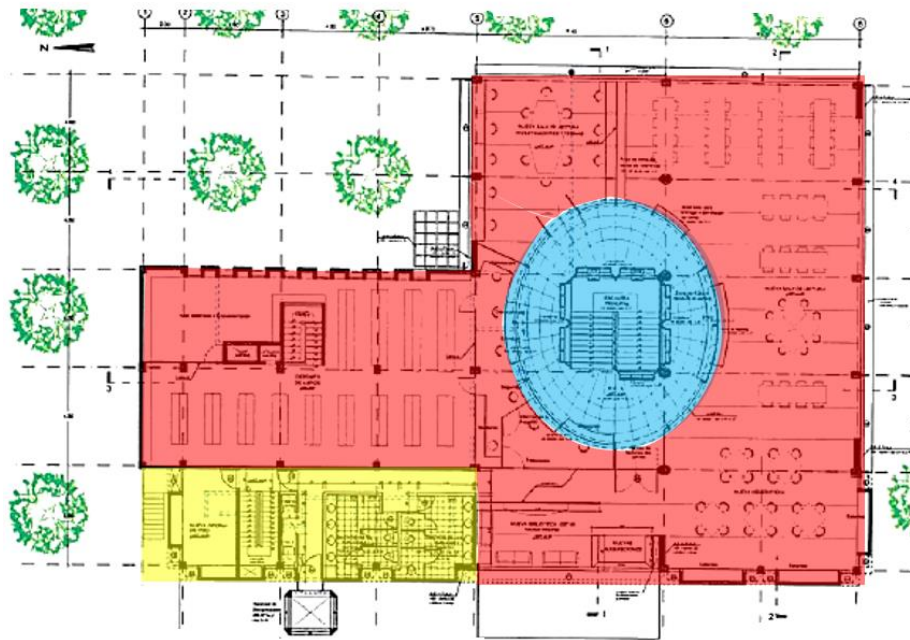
Planta Entre Piso del Centro Cultural El Olivar
